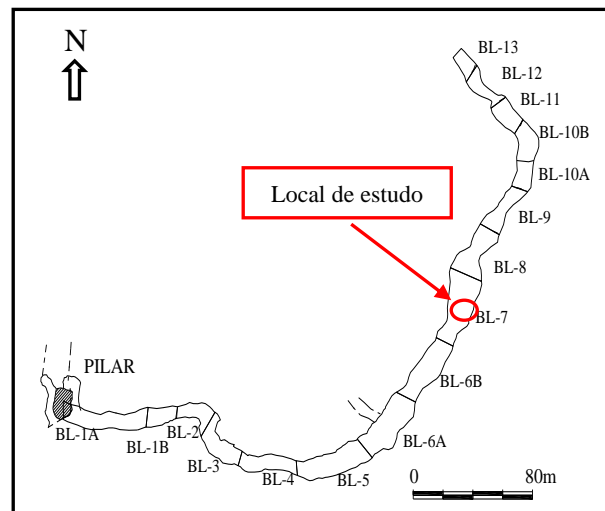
Visualização em planta do realce 10.2 FGS com localização do bloco 7.
